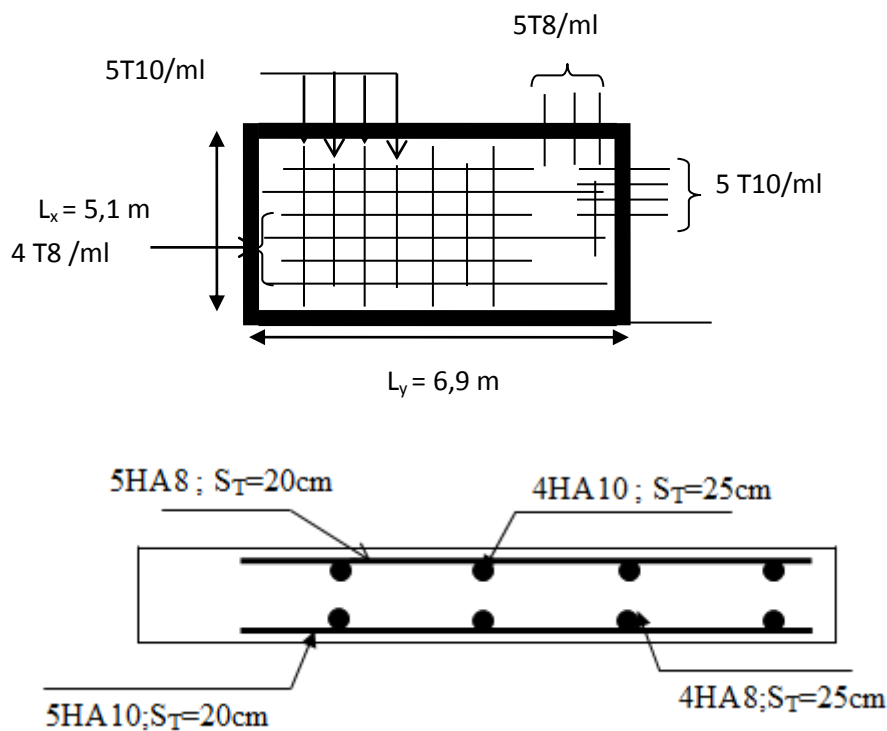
Ferrailage de la dalle pleine sur 04 appuis (type 01).
